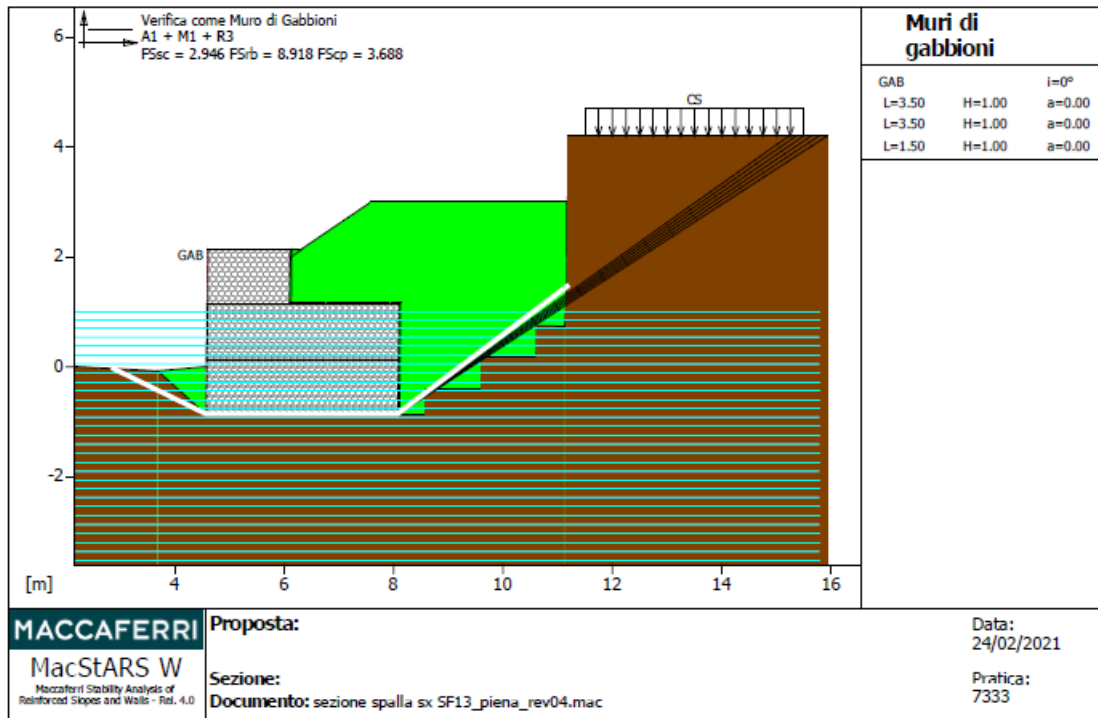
Verifica come muro di sostegno sezione spalla sx- condizione di piena -statica
